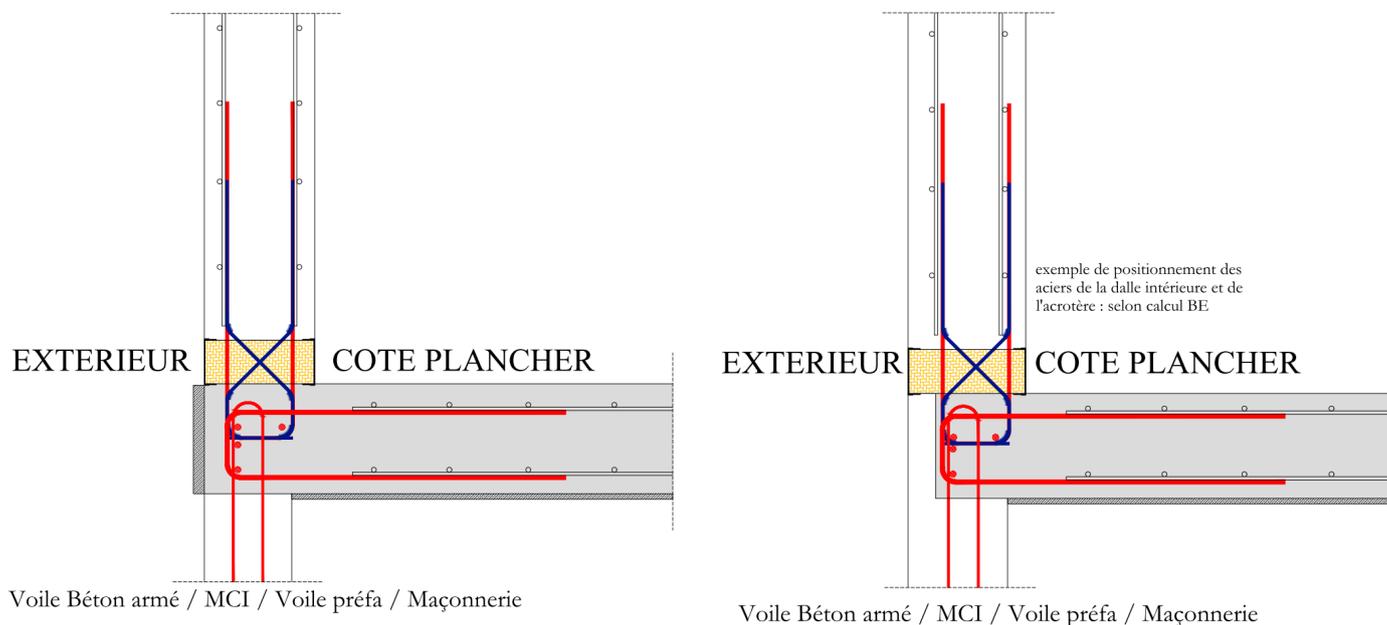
Détail après coulage du béton de la dalle, à gauche voile mise en place du coffrage de rive après coup, à droite coffrage de rive coulé avec le voile.
